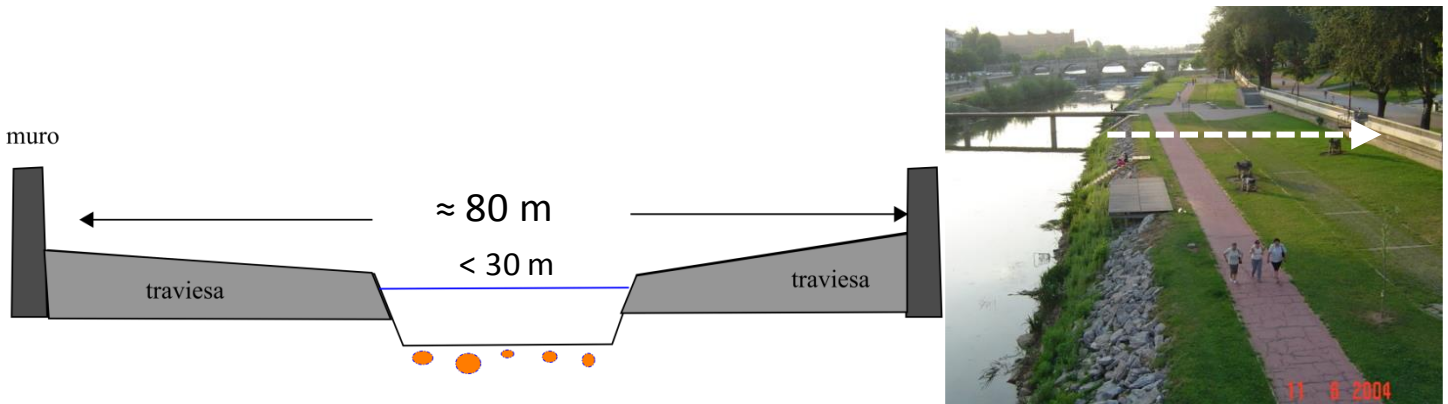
Croquis en sección transversal de la ganancia de anchura que se propone, haciendo aluvial toda la anchura entre muros (80 m), con la probable demolición o rebaje de las traviesas (al menos las partes sombreadas en gris). (derecha) Aplicación a un lugar céntrico de León (foto de 2004, ya presentada en la Figura 13).
